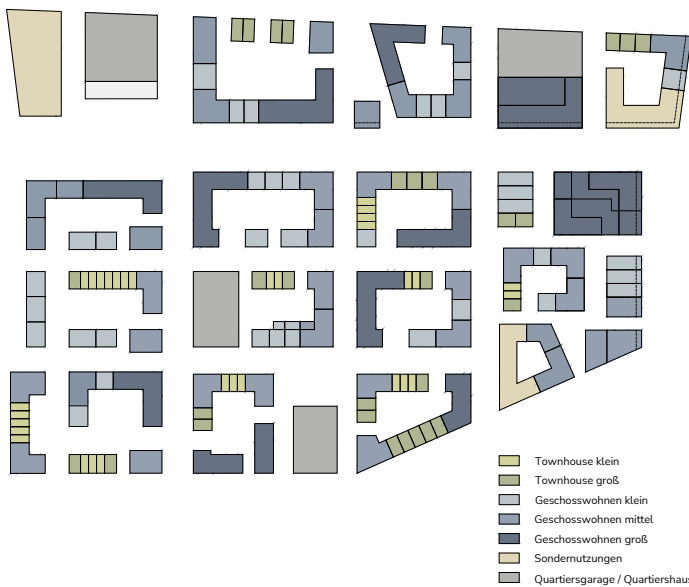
Gebäudetypologien in Dietenbach, erster Bauabschnitt
